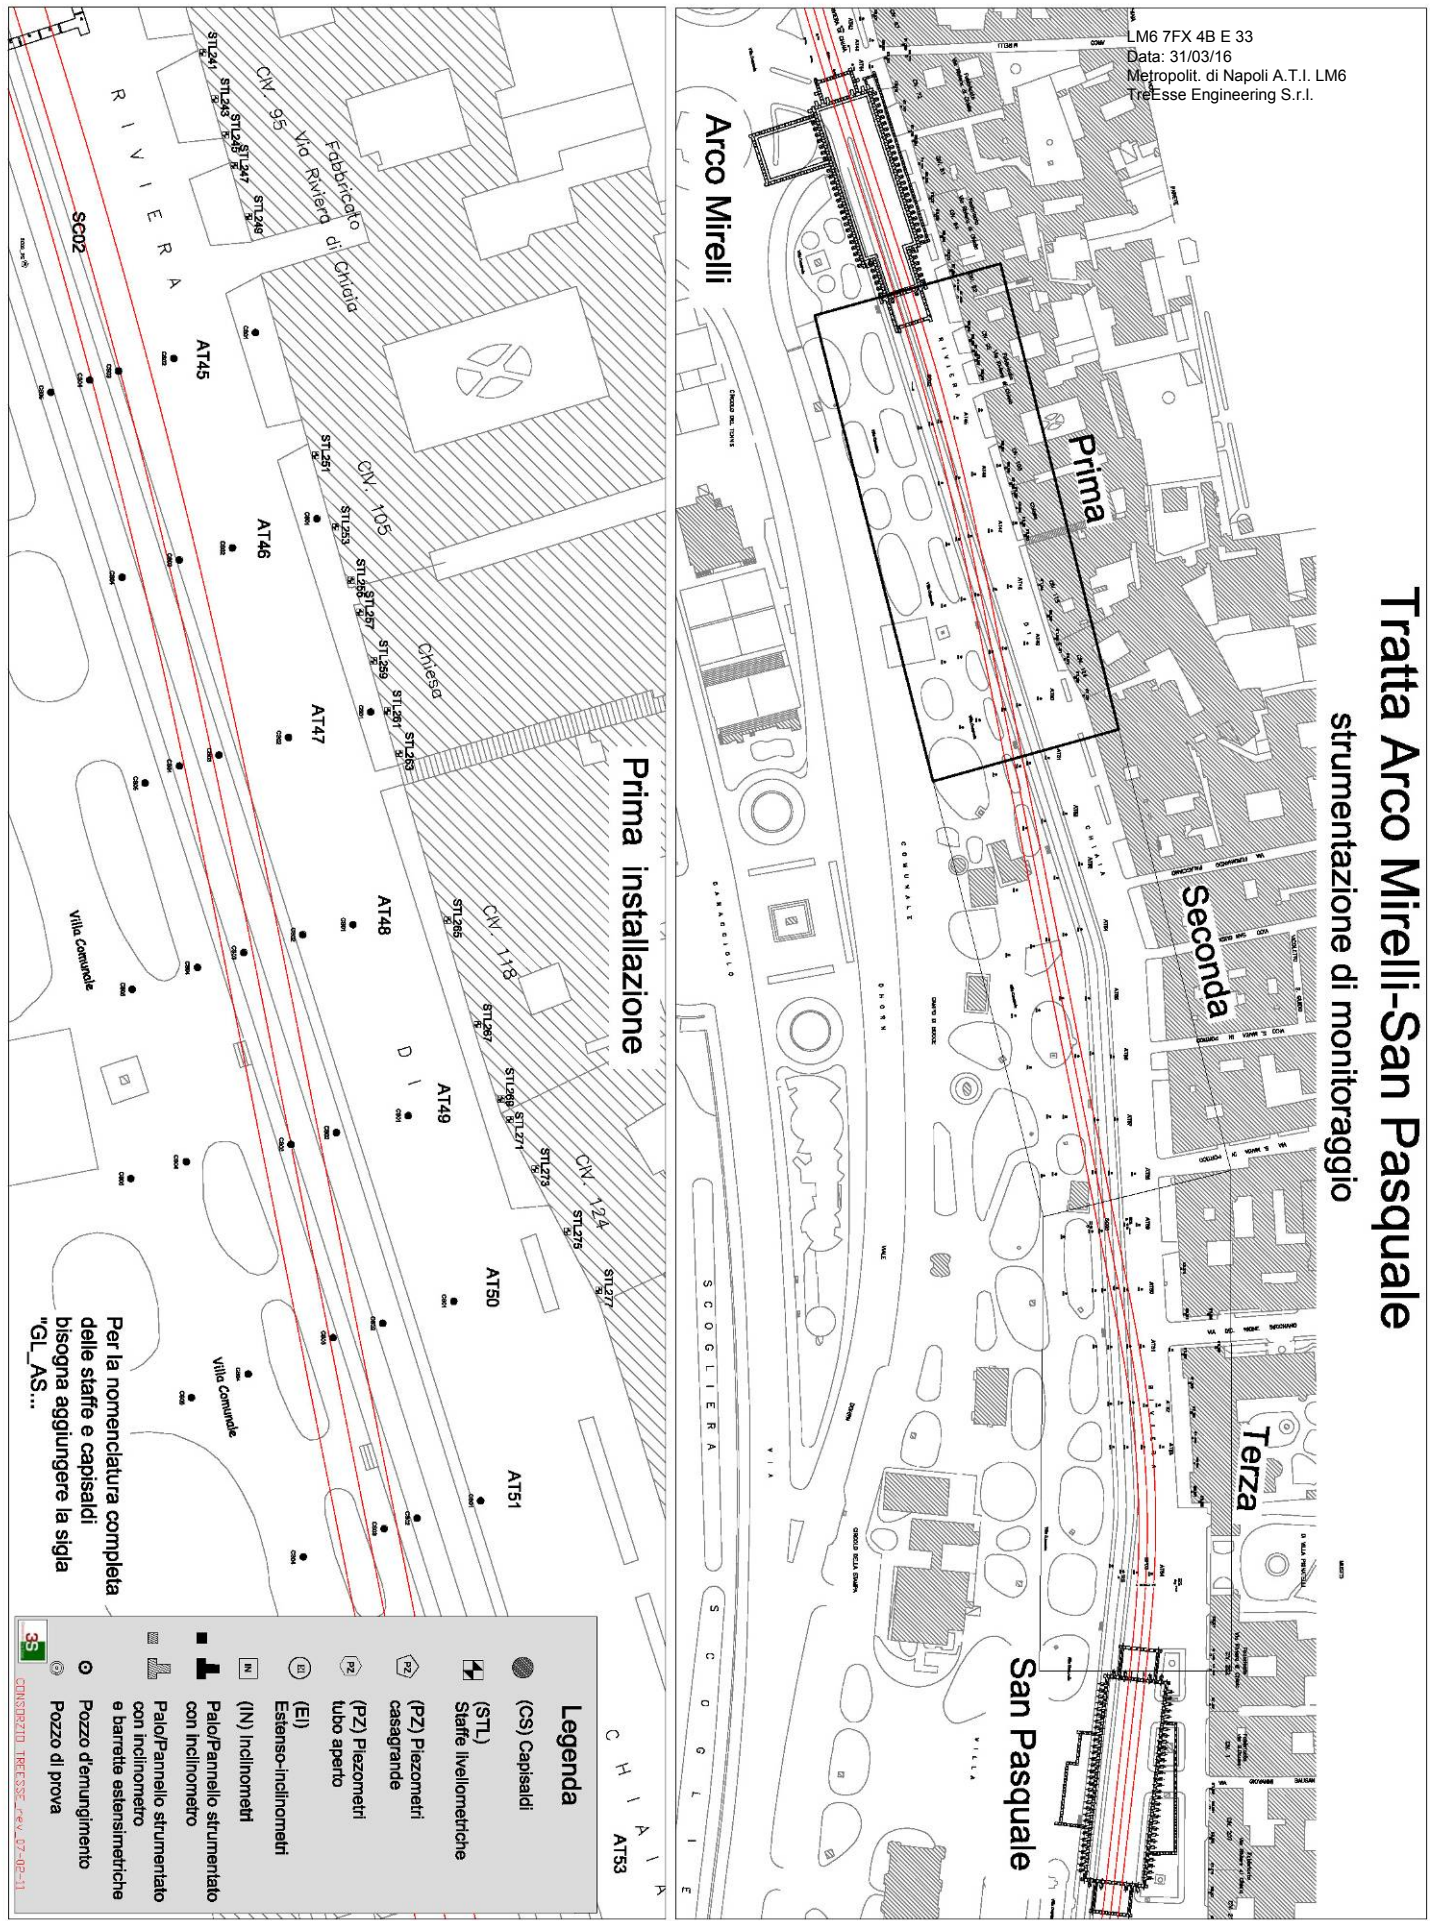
Planimetria tratta Arco Mirelli-San Pasquale, raffigurante la disposizione della prima installazione della strumentazione di monitoraggio.
